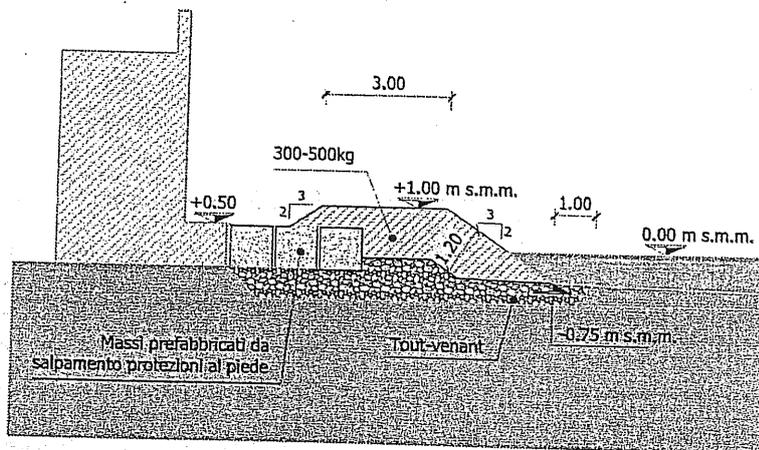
Sezione tipo della protezione al muro lungo Viale delle Sirene
